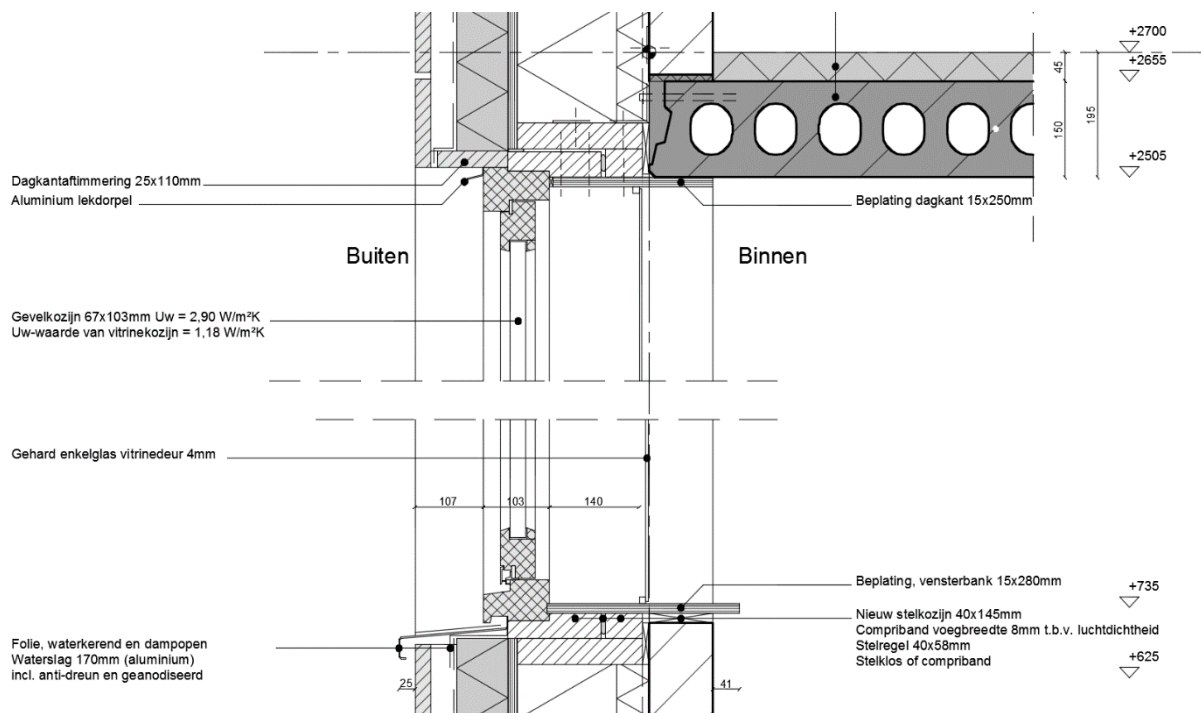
Fragment detailblad 1, bestaande situatie Achterdonk 60, kozijnaansluitingen
